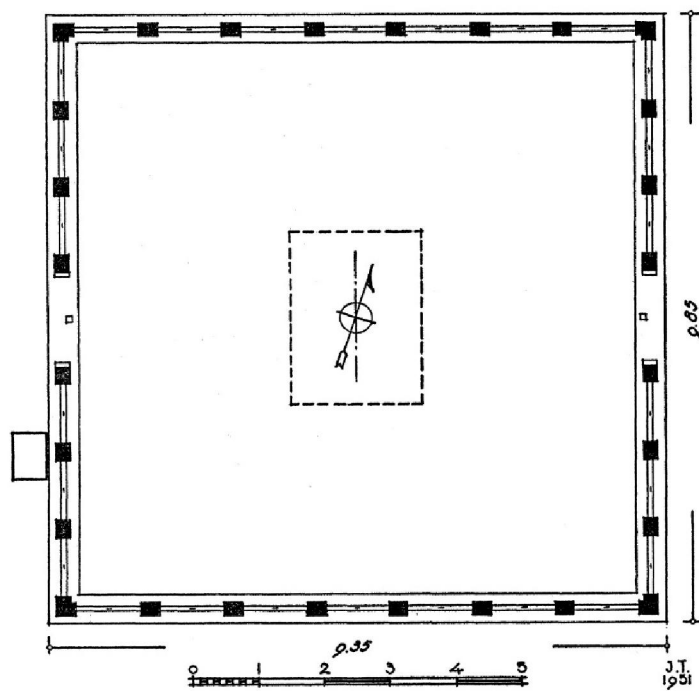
Pianta del parapetto di I Fase (Thompson 1952)
